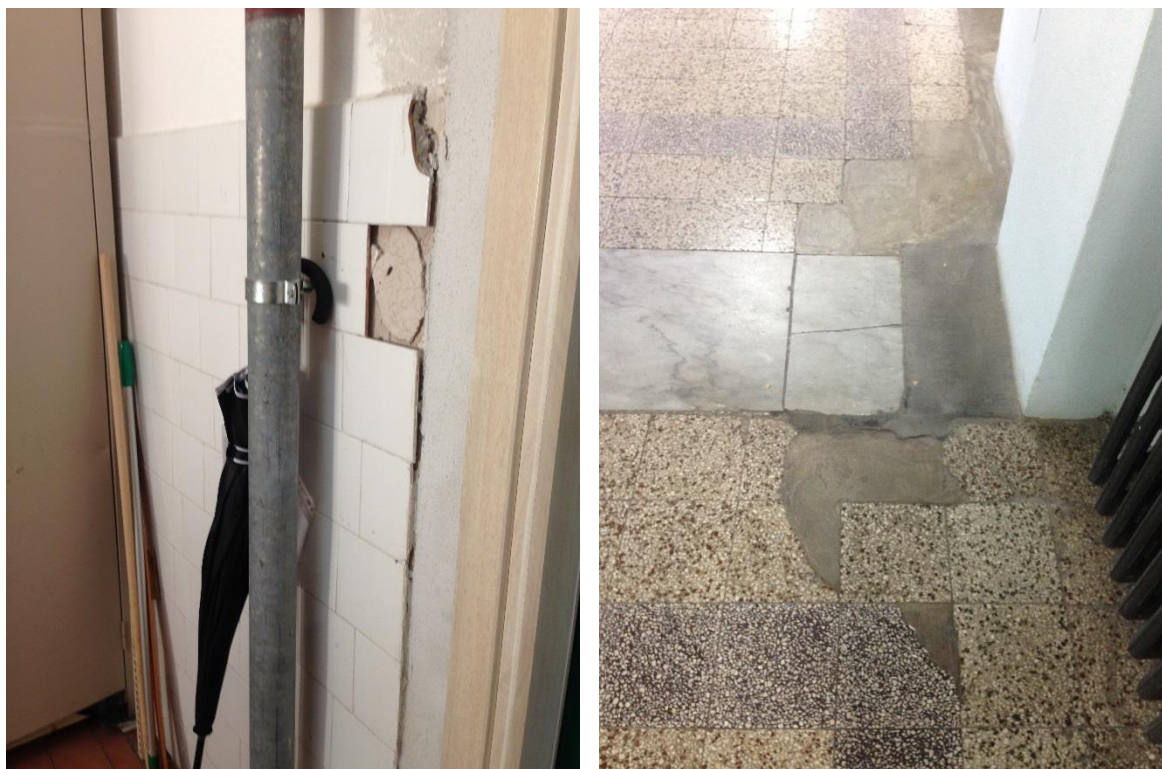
Dettagli dei rivestimenti e delle pavimentazioni
